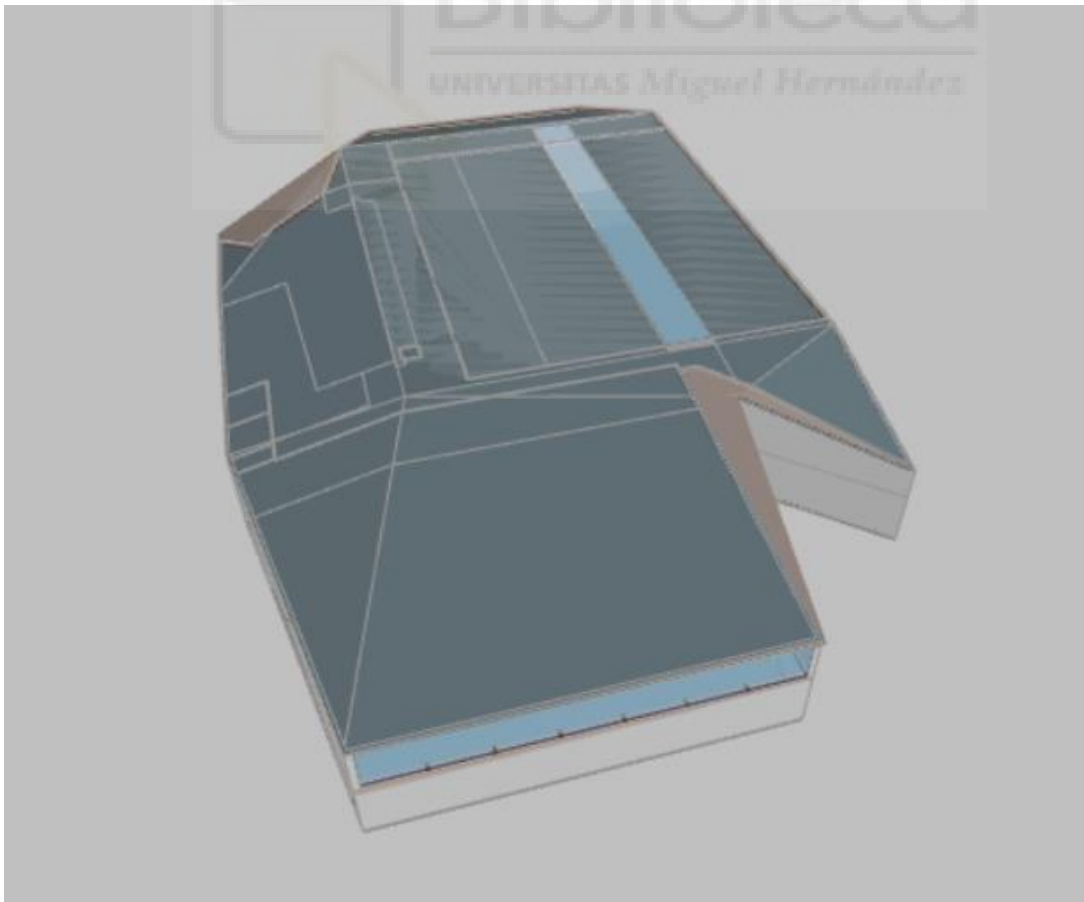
Vista 3D, exterior del edificio con cubierta, con fachada y con lucernario
